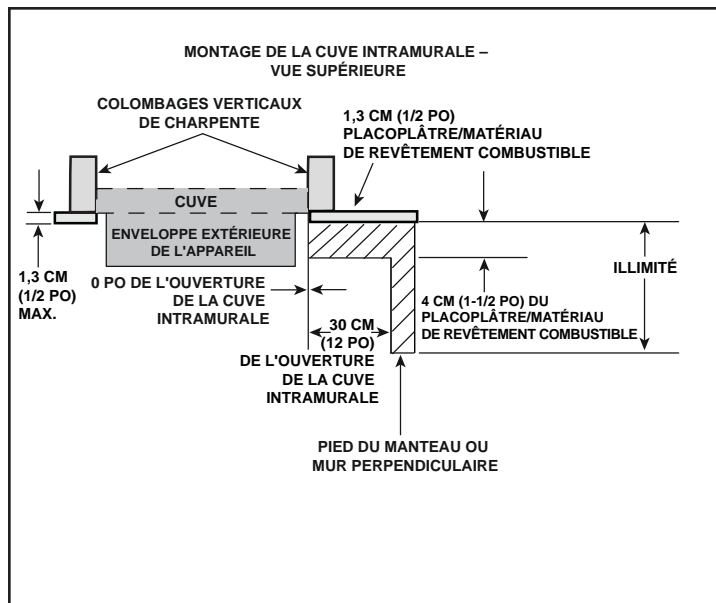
Dégagements du pied du manteau de foyer ou saillie du mur (acceptable de part et d'autre de l'ouverture)
